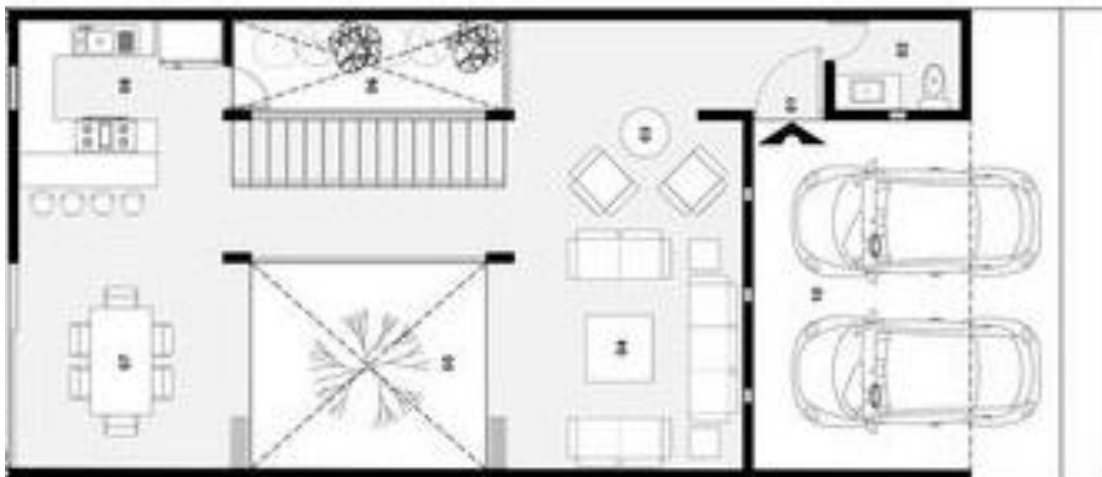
"Durchgesteckter Grundriss"
